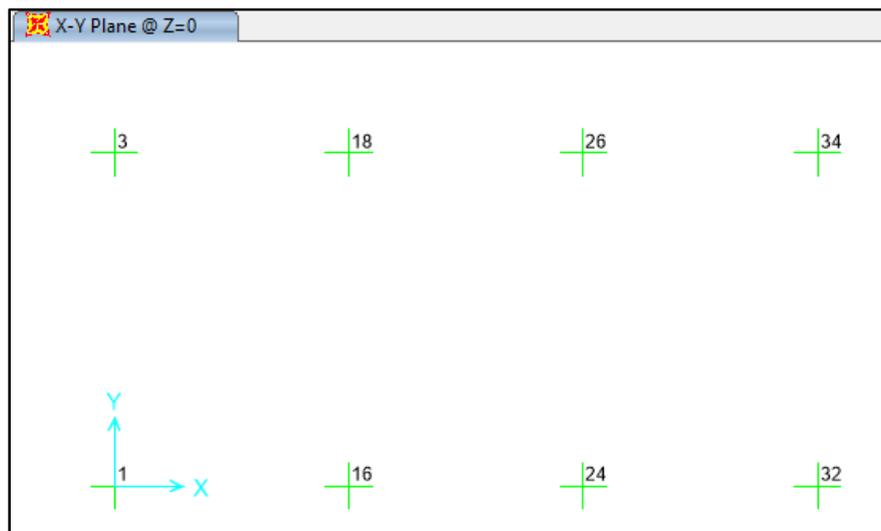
Planta de apoyos en SAP2000 v20 con etiquetas asignadas
